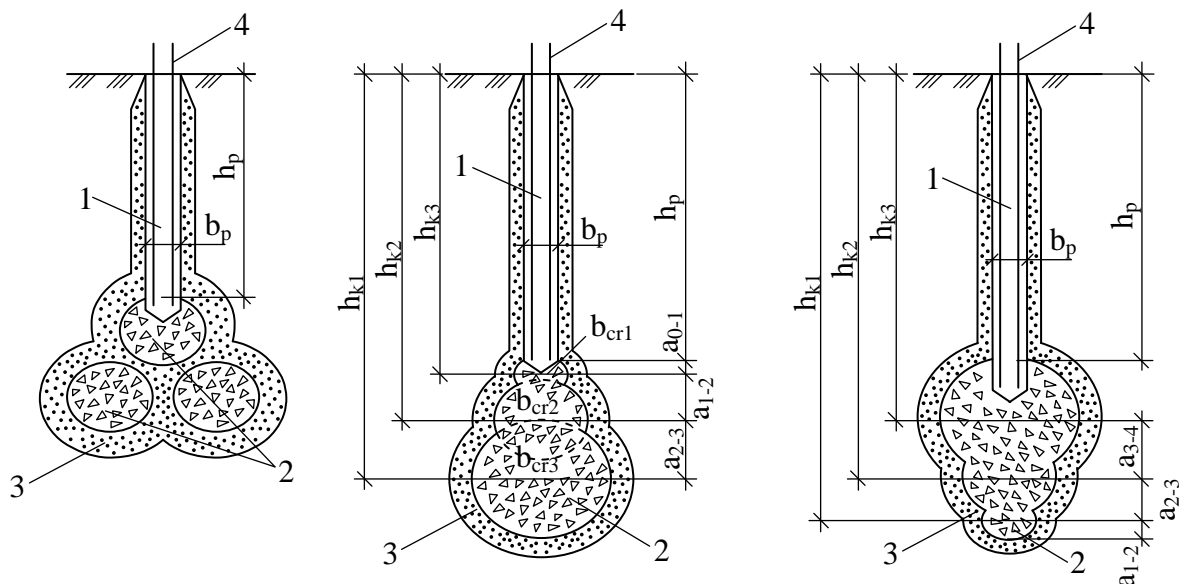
Фундаменти в пробитих свердловинах із розвиненими розширеннями: 1 – стовбур фундаменту; 2 – розширення з жорсткого матеріалу; 3 – ущільнений ґрунт; 4 – арматура
